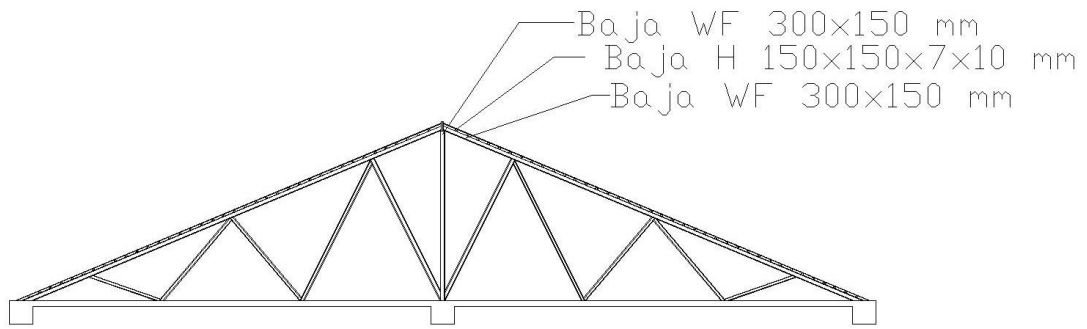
Struktur rangka bangunan dengan modul grid
